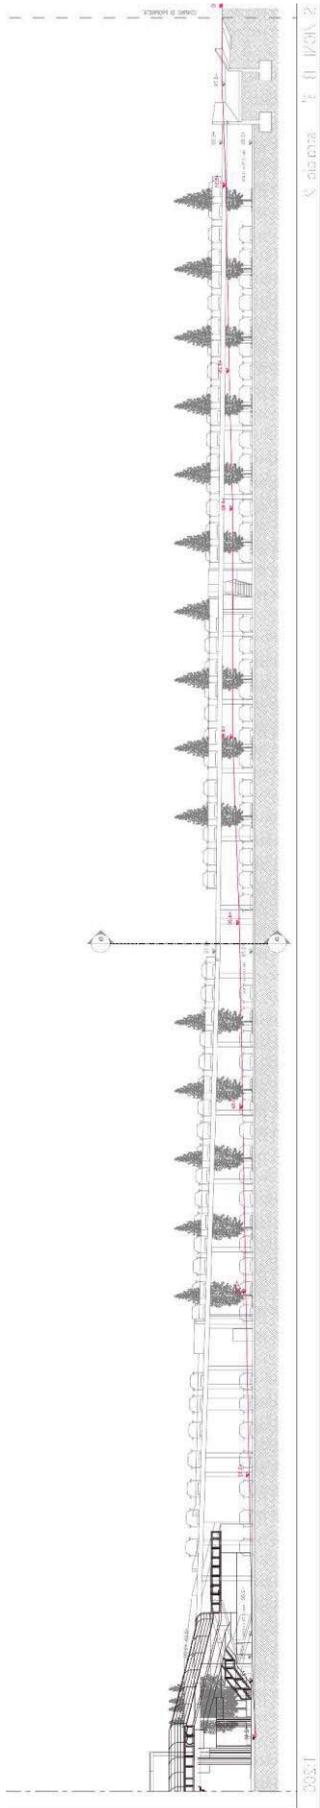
Sezione longitudinale del piazzale lato sud, nello stato di progetto (la linea rossa rappresenta la quota del terreno nello stato attuale)_EL.P.09_Sezioni AA-BB-CC-DD
